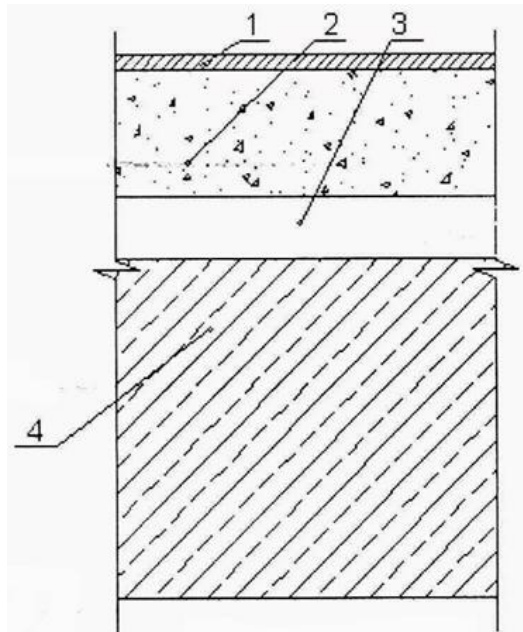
Розрахункова схема підлоги: 1 – чиста підлога з лінолеуму, 2 – цементно-піщана стяжка, 3 – звукоізоляційний шар з мінеральної вати, 4 – залізобетонне міжповерхове перекриття.
